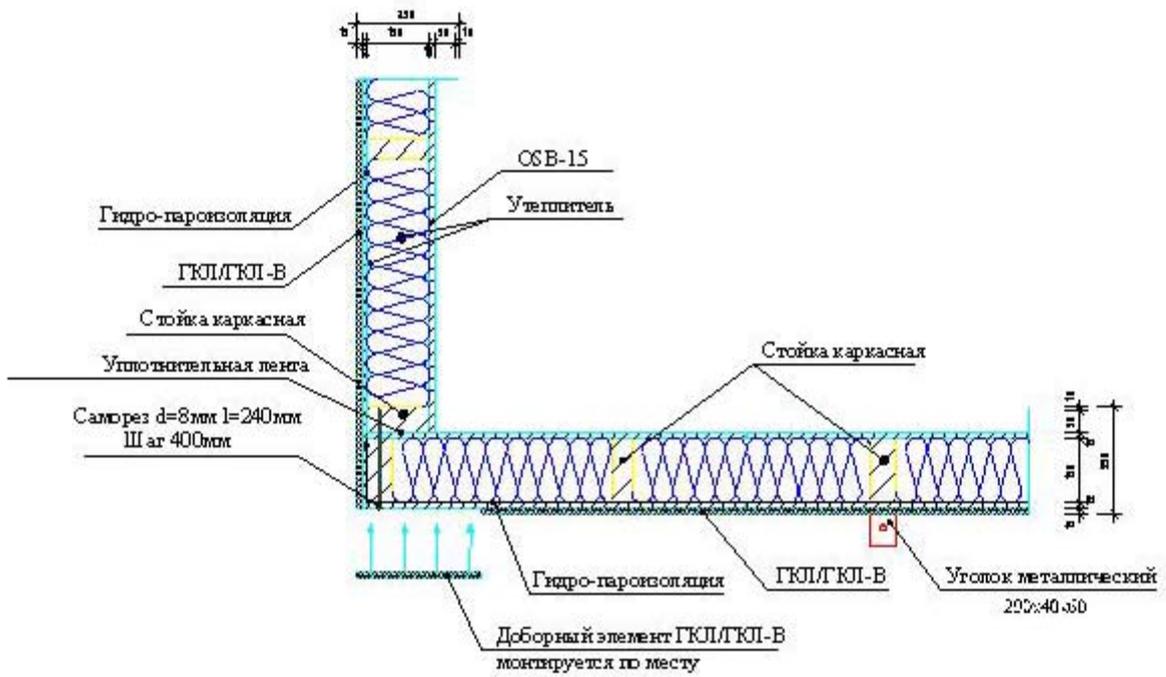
Угол углового крепления наружных стеновых панелей. Тип 2
